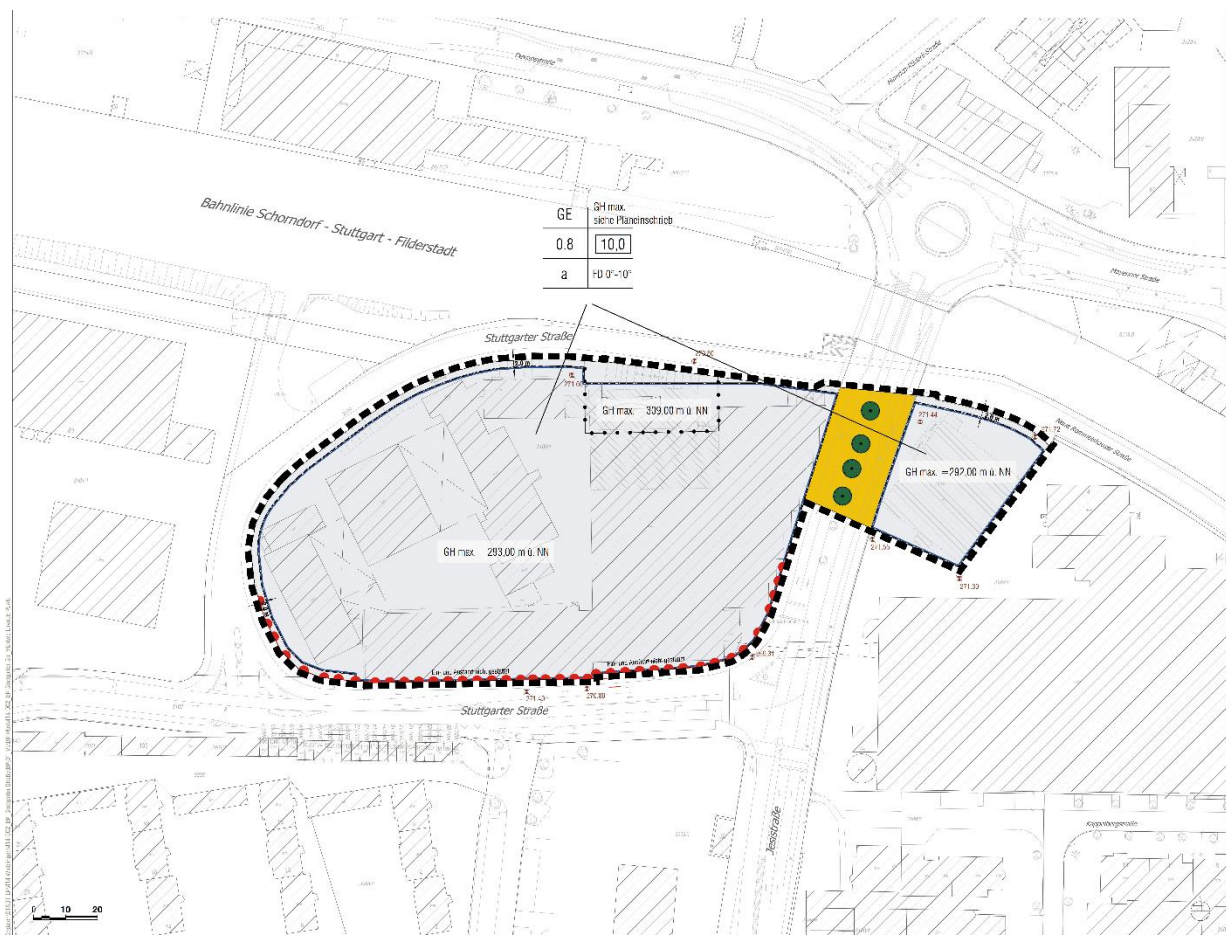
Bebauungsplan „Stuttgarter Straße / Jesistraße“
